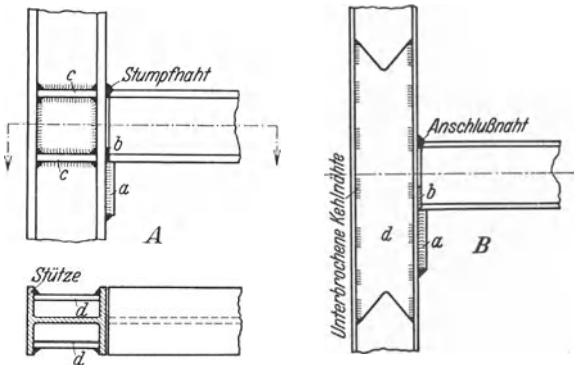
Anschluß von Deckenträgern an Geschoßbaustützen.
